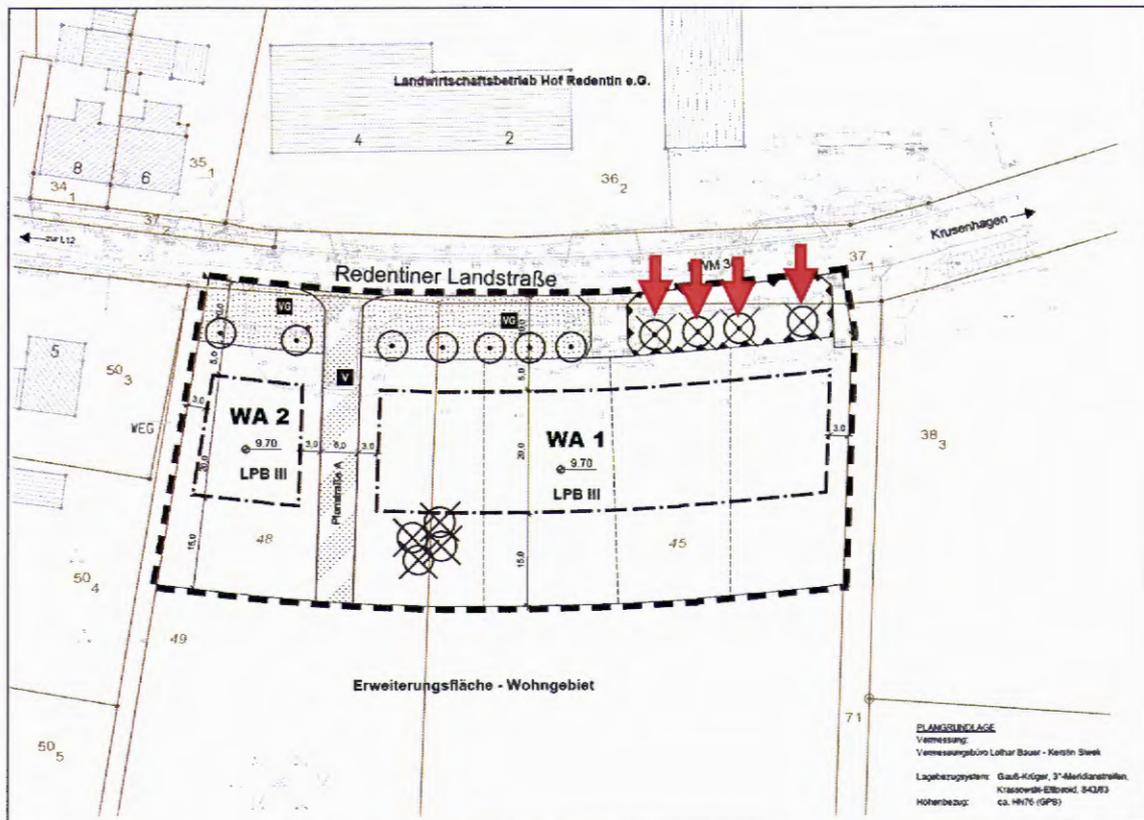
Ausschnitt des B-Plans Nr. 7 und Darstellung des Plangebietes. Die im Entwurf vorsorglich noch als Verlust festgesetzten Bäume bleiben infolge der bereits mit einem Fundament vorbereiteten baulichen Ausführung als Schallschutzwand erhalten. Quelle: BAB Wismar 2016.
